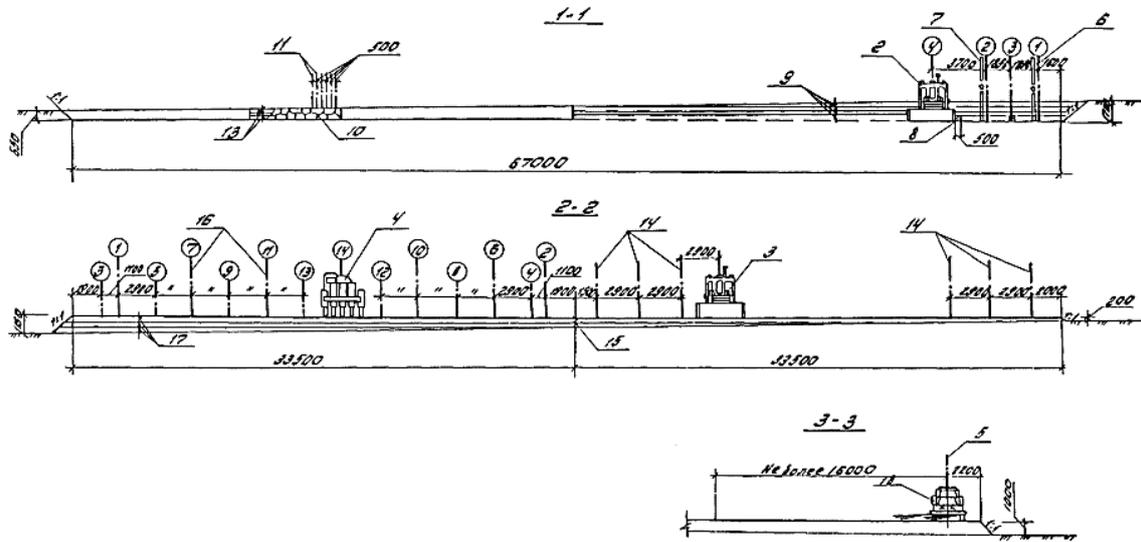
Схема перемещения грунта из выемки в насыпь (продолжение):
